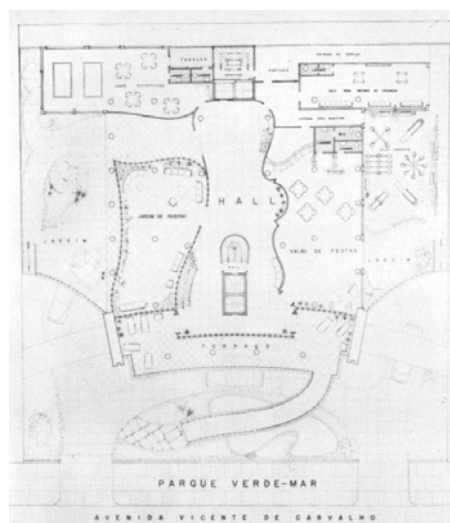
Planta do pavimento térreo. Nota-se o traçado orgânico das linhas que compõem os espaços. Fonte: Revista Habitat nº 7, p. 109.
